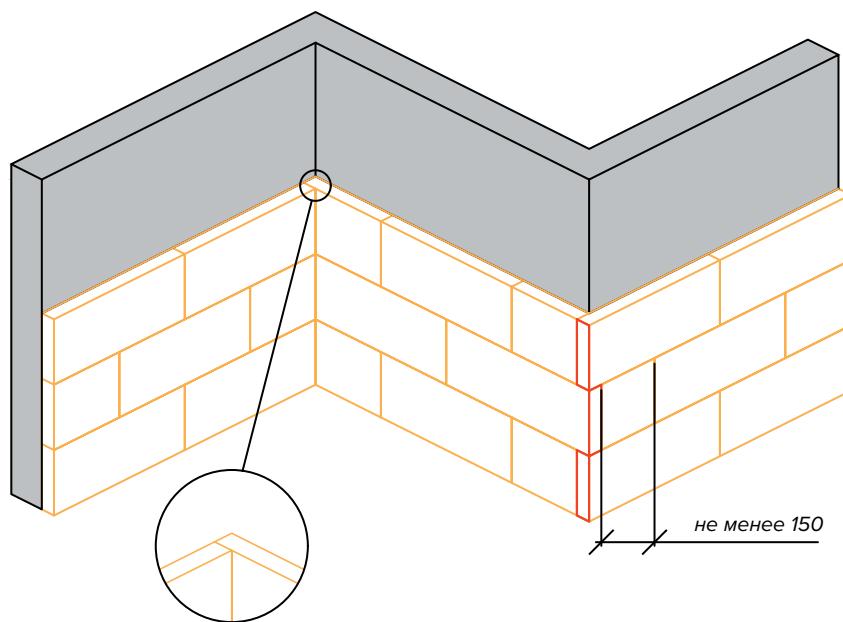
Система фасадная теплоизоляционная композиционная. Общий вид
